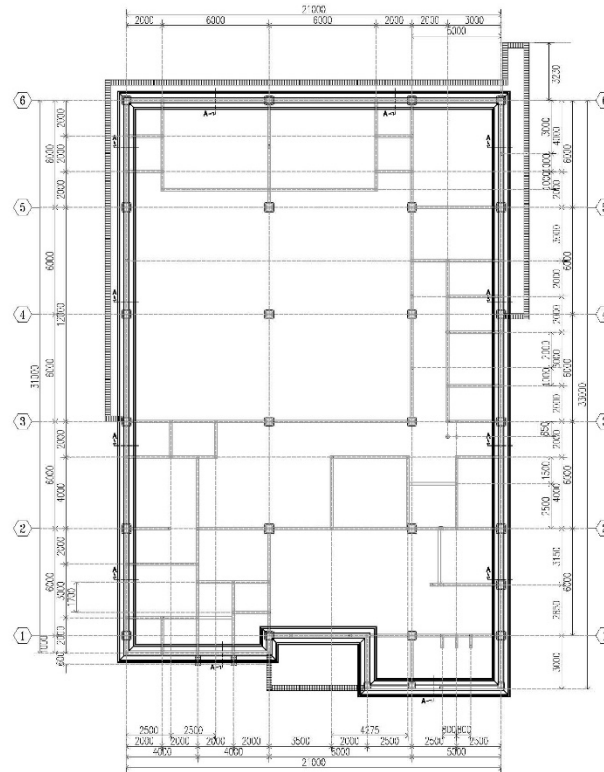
Denah Pile Cap Alt.3 Pondasi Bore Pile
